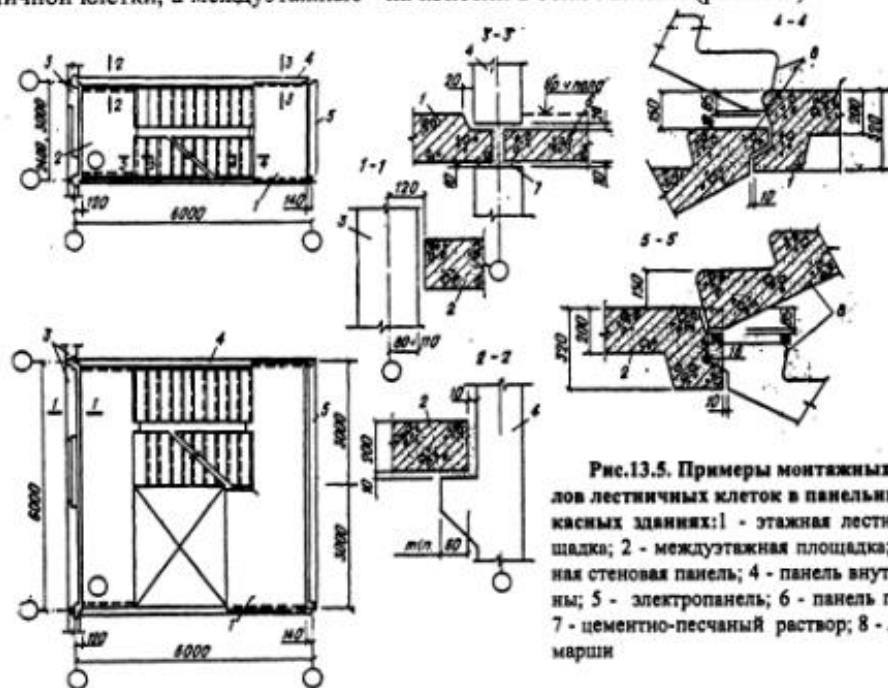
Примеры монтажных схем и узлов лестничных клеток в панельных бескаркасных зданиях: 1 - этажная лестничная площадка; 2 - междуэтажная площадка; 3 - наружная стенная панель; 4 - панель внутренней стены; 5 - электропанель; 6 - панель перекрытия; 7 - цементно-песчаный раствор; 8 - лестничные марши
